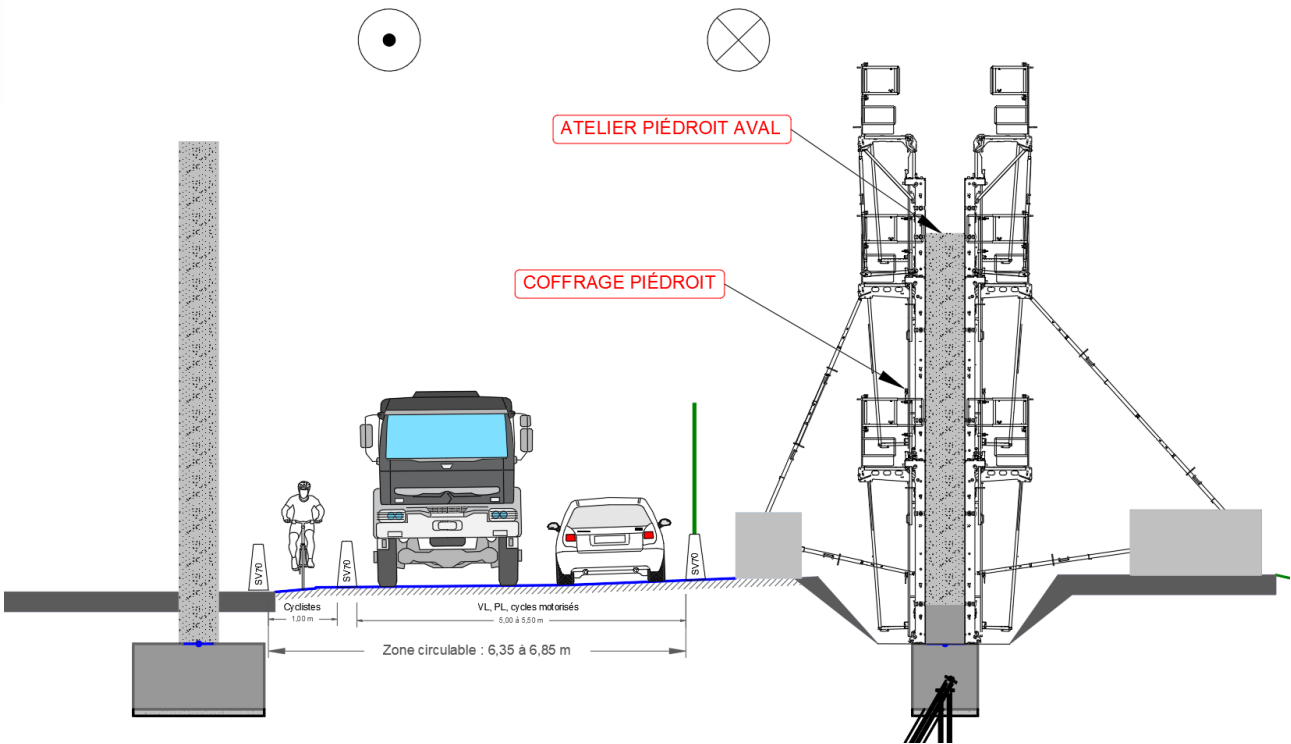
Coupe au droit d'un poste de réalisation du piédroit aval
